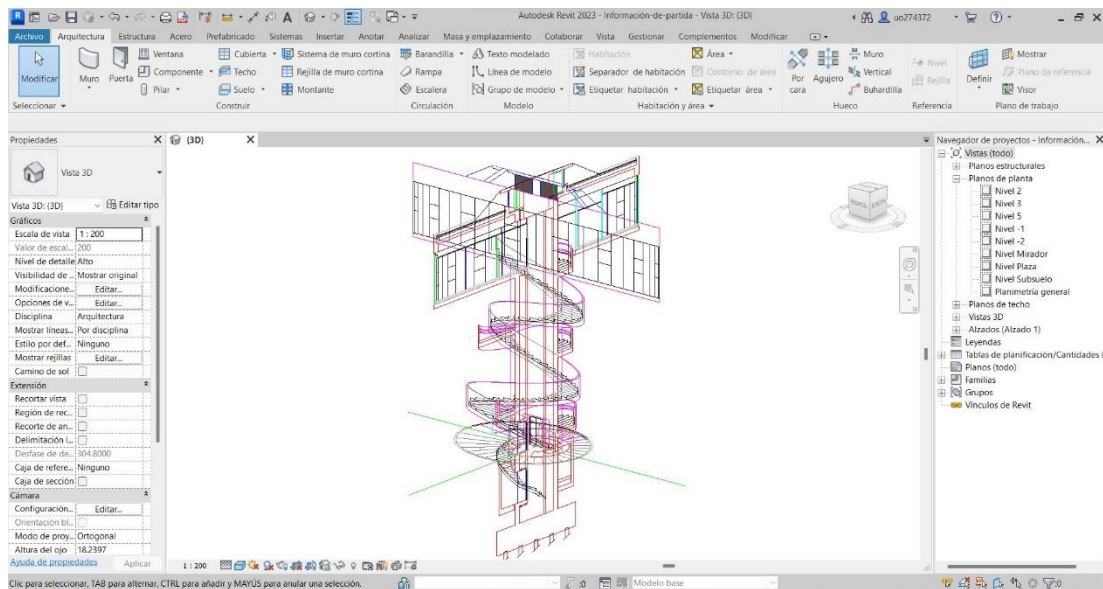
Todos los planos de planta y alzado importados en Revit (Vista 3D)
